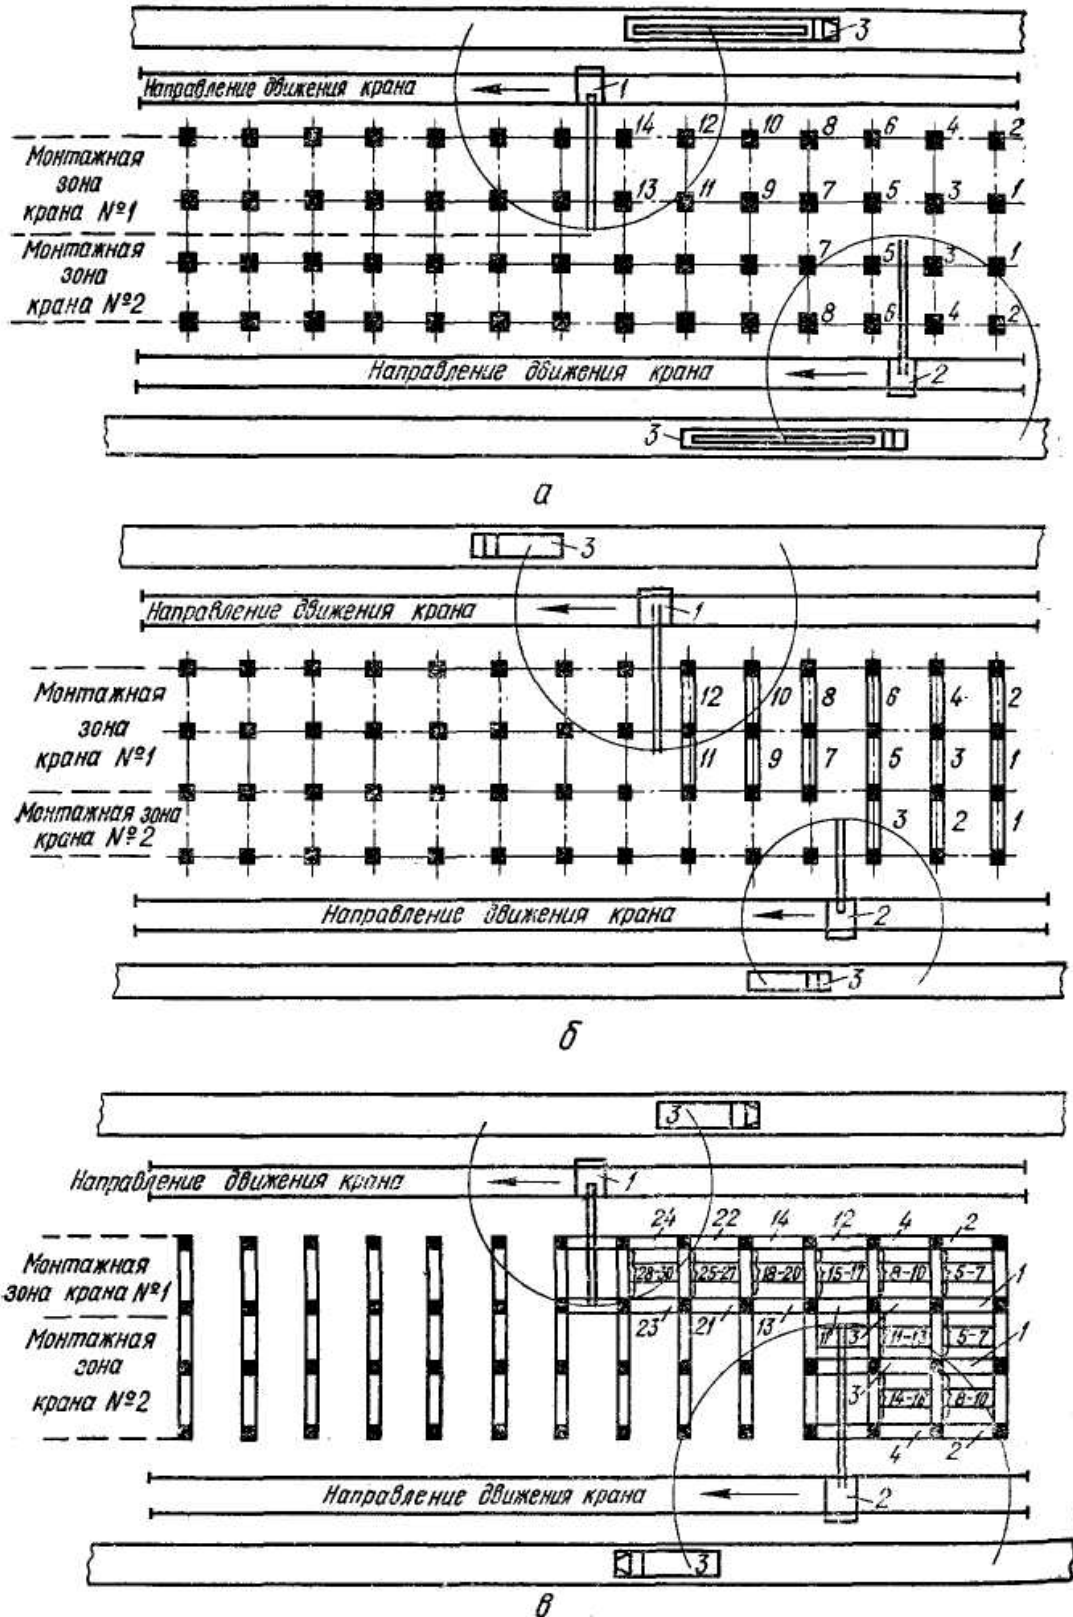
Схема монтажу каркасу з розташуванням двох баштових кранів з двох сторін будівлі: а – монтаж колон; б – монтаж ригелів; в – монтаж плит перекриття; 2— баштовий кран № 1; 2 — баштовий кран № 2; 3 – транспортний засіб ; 1, 2, 3 ... – послідовність установлення збірних елементів
